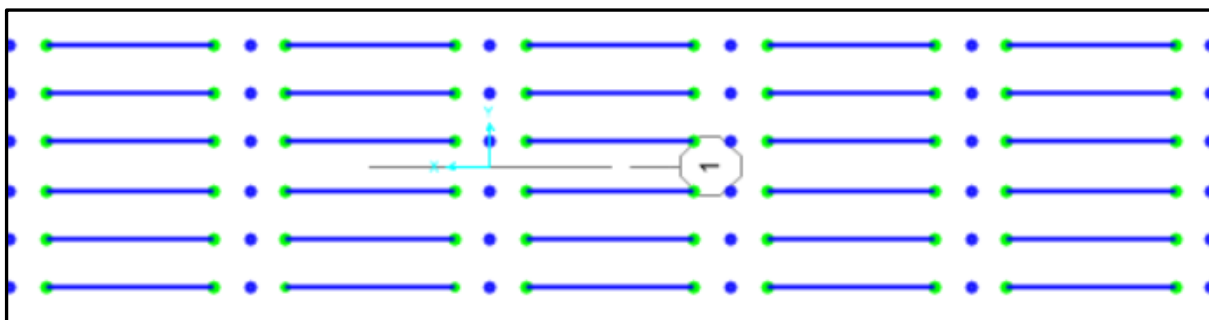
Vista em planta da ligação da longarina no modelo de calculo ("Assign Frame Release")
